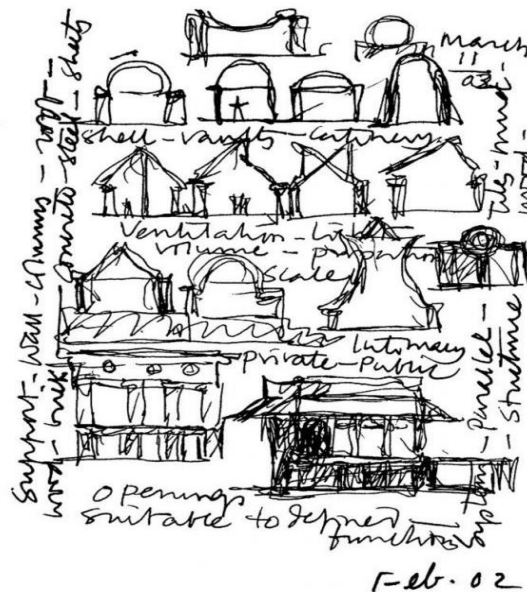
Croqui do CEPT (Fonte: Archdaily)
